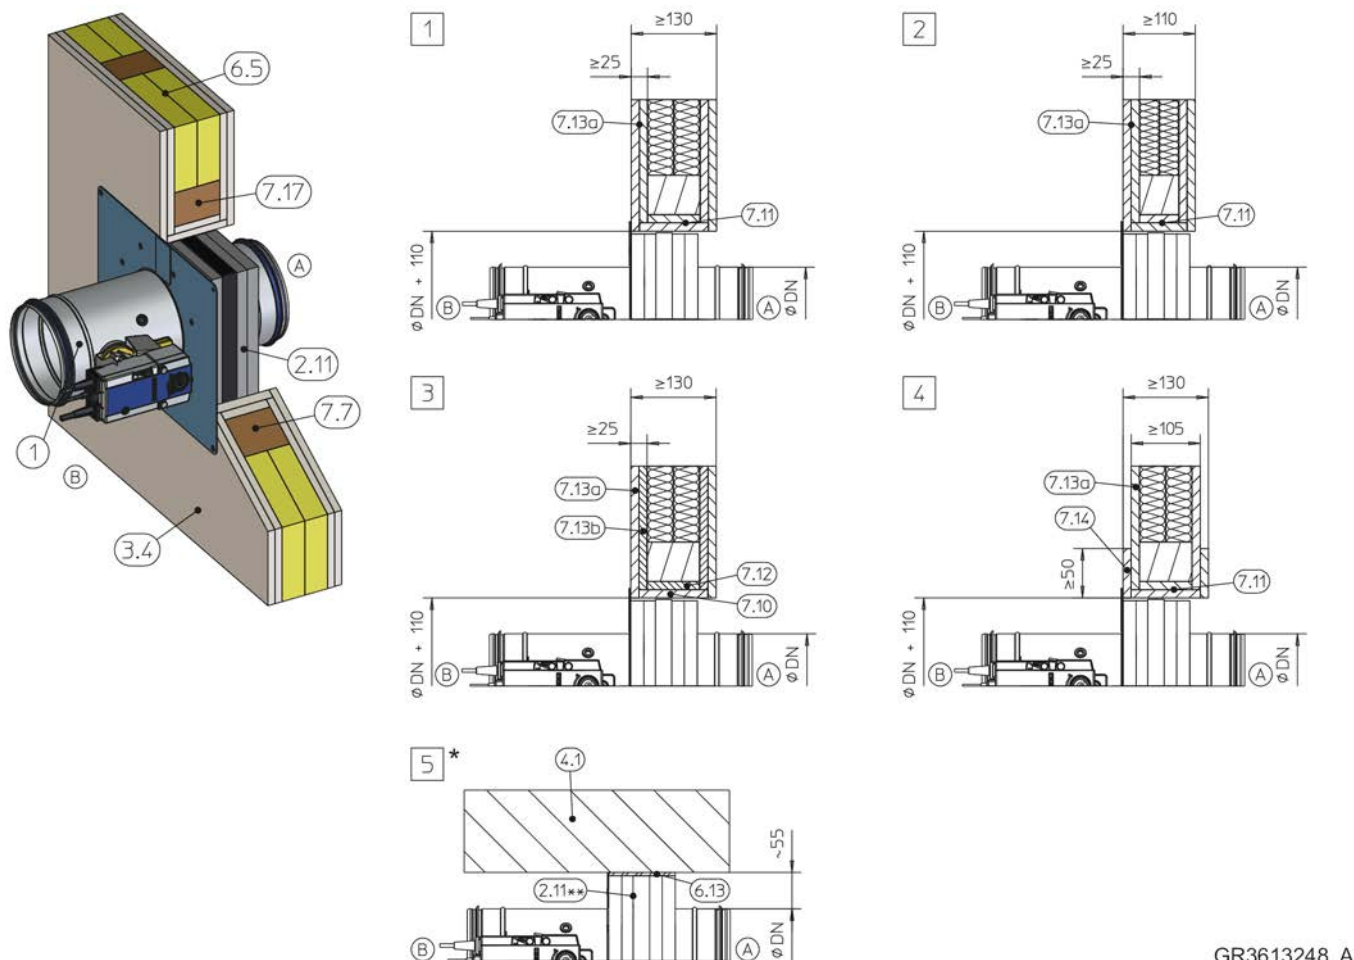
Mørtelbasert montasje i lett skillevegg med bindingsverkkonstruksjon, flens til flens. Illustrasjonen viser side om side montasje (gjelder også montering av spjeld over hverandre)
